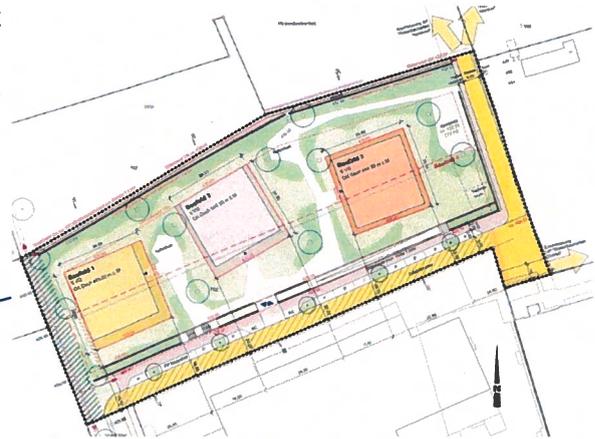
GB 702, Ausschnitt aus Gestaltungsplan- / Erschliessungsplan Rickenbacherfeld Südwest
